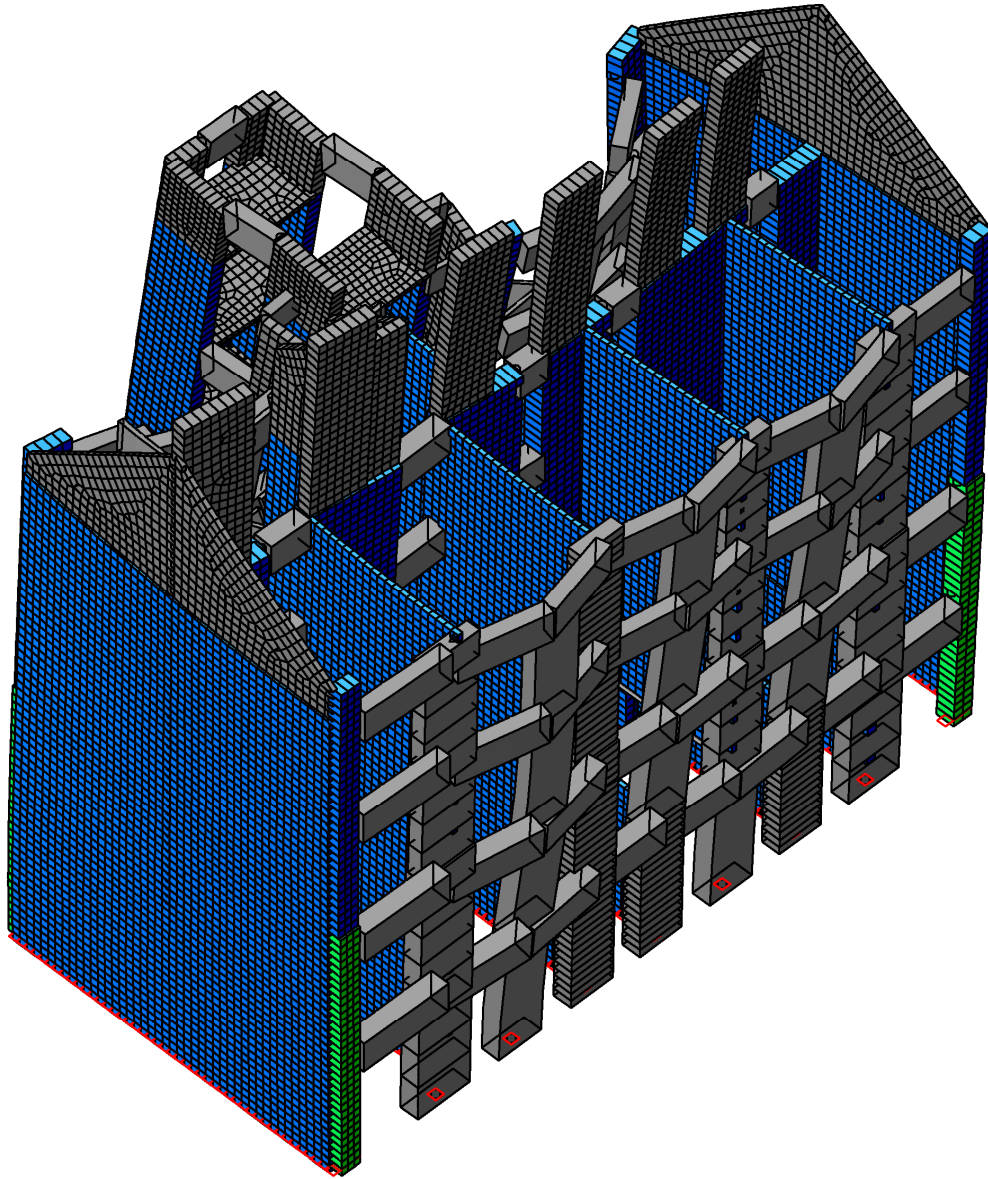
Haus ohne Schließen, Horizontalauslenkung in Querrichtung
